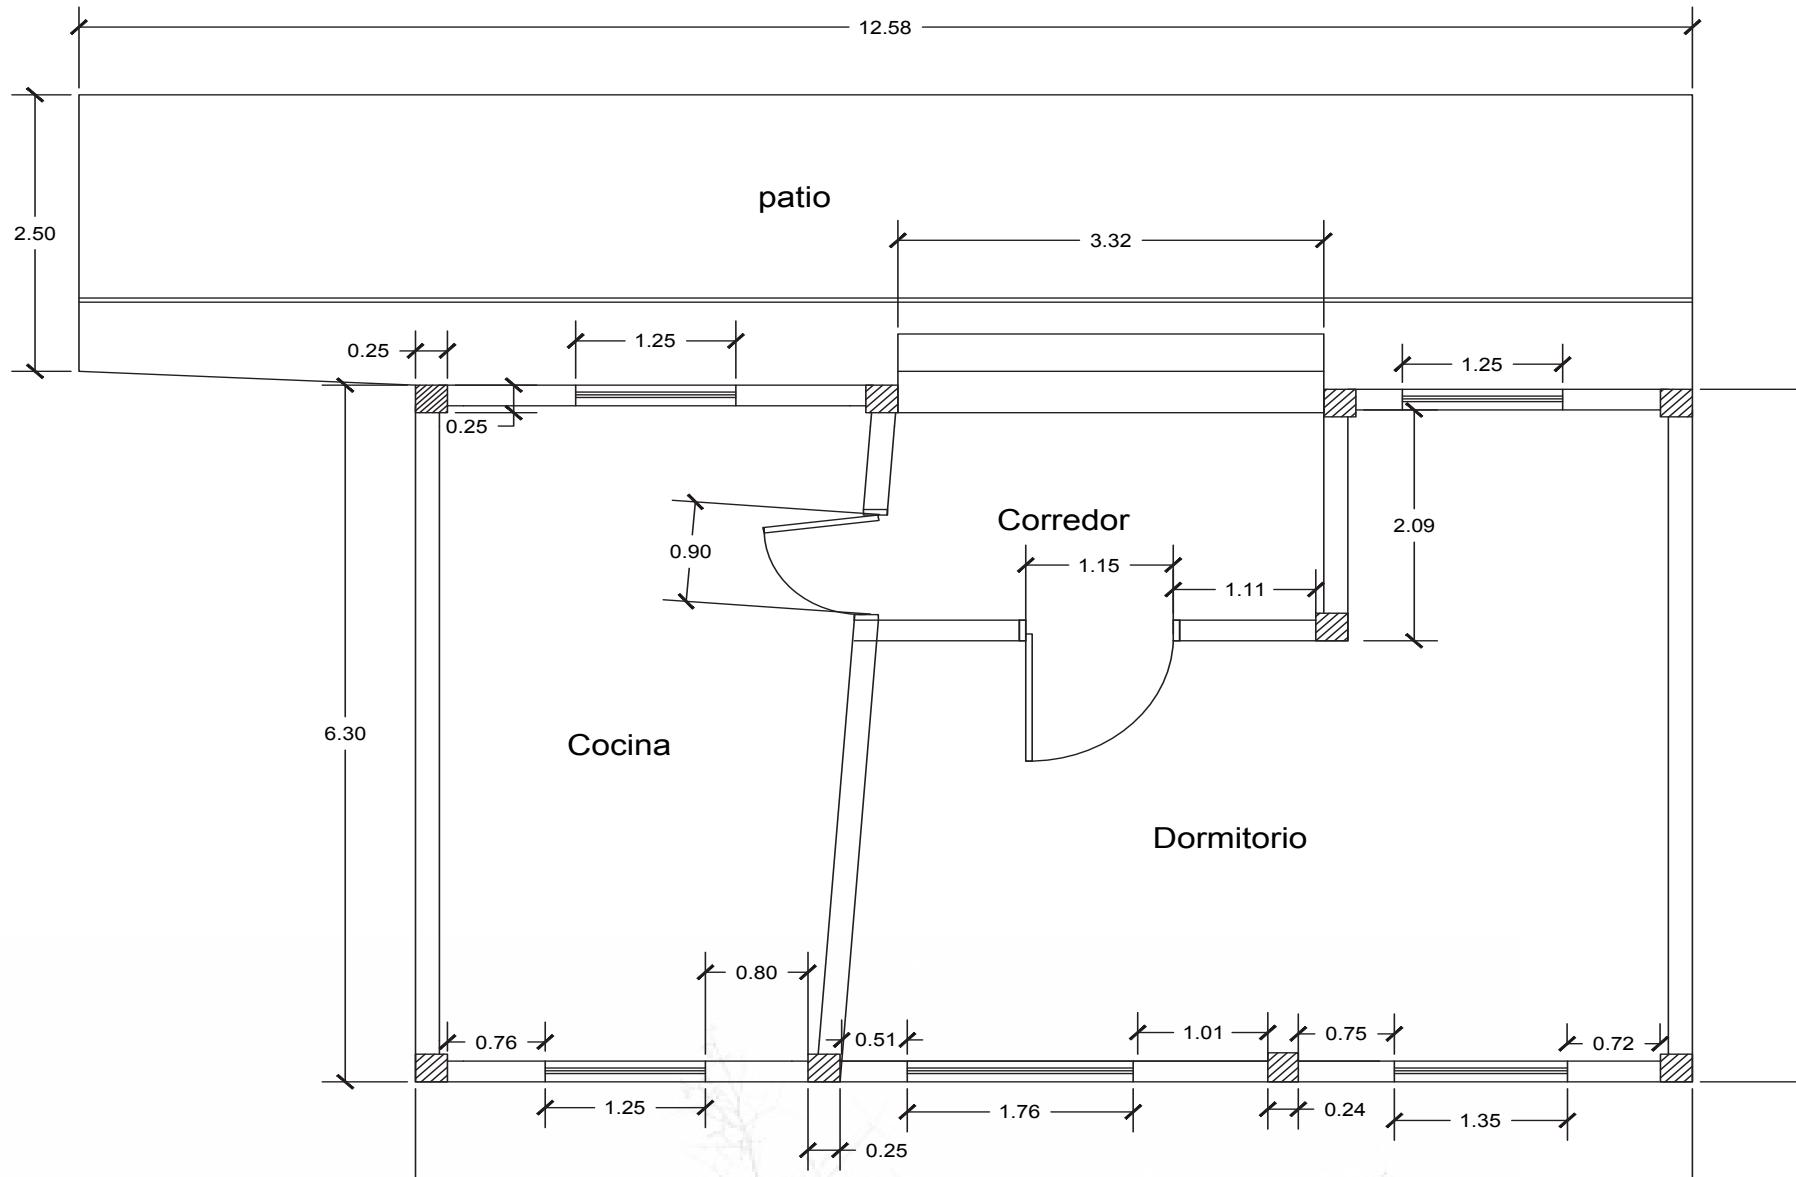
Planta estado actual de la vivienda. (Romero, 2018).
